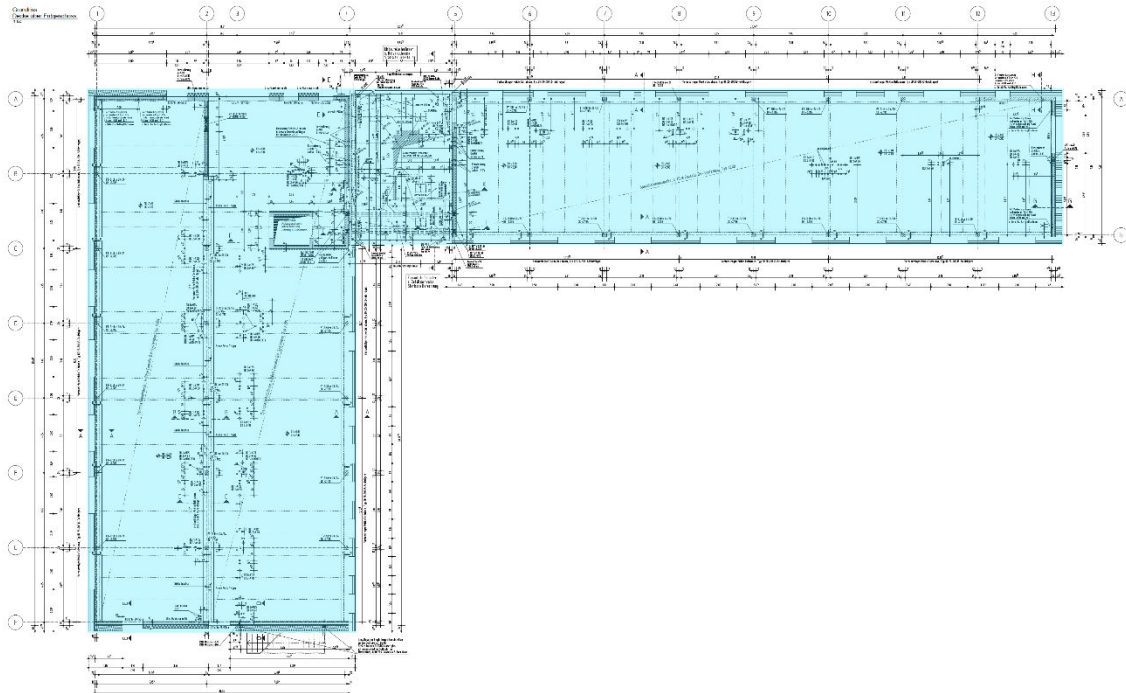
Systemgrenzen im Grundriss EG, Haus
